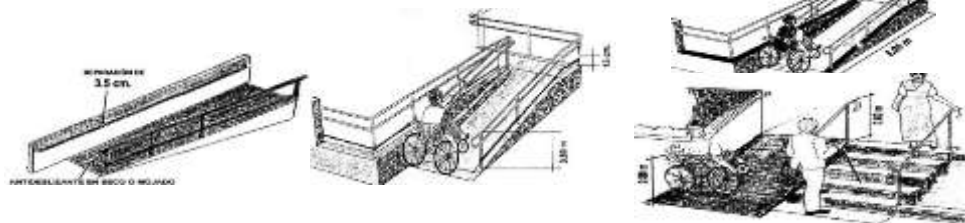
Parapetos y barandas de seguridad rampas y escaleras.
